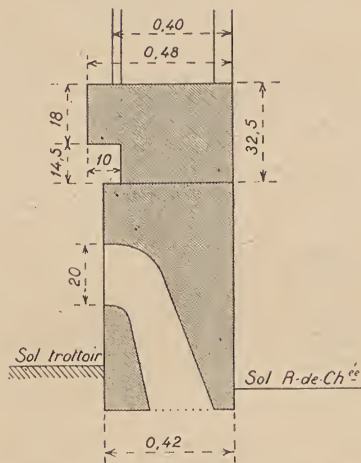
Coupe d'une allège de croisée, d'un bandeau d'appui et d'un soupirail.
